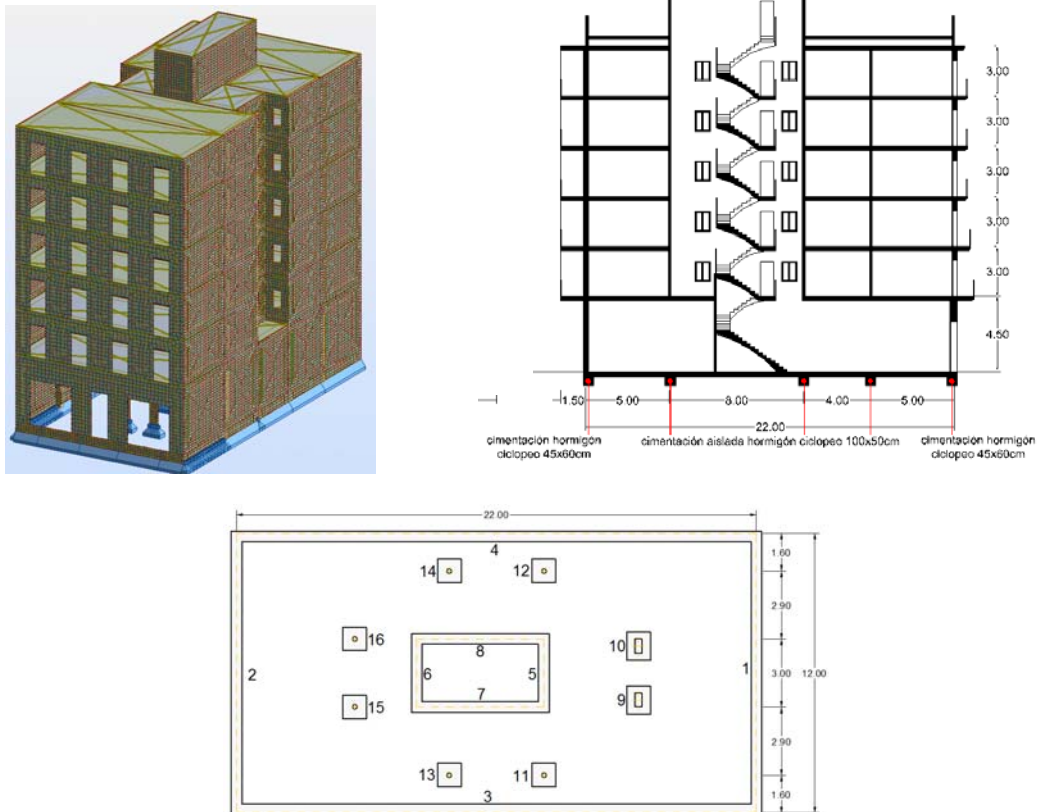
n Arquetipo II. Axonometría, sección y cimentación.
